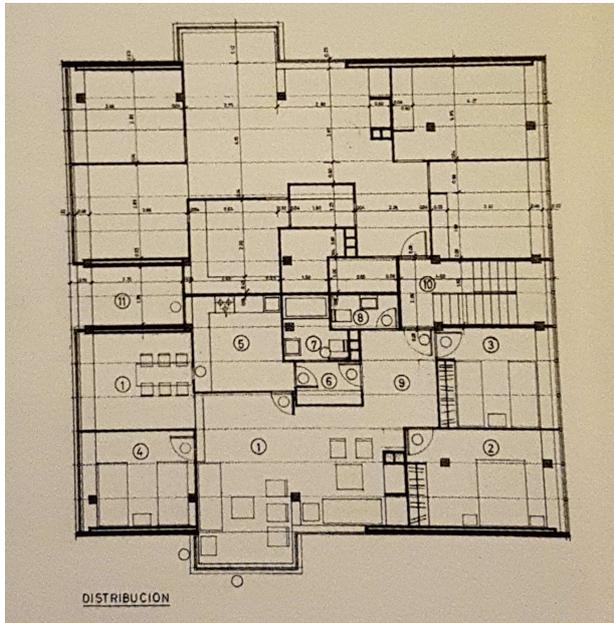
Planta Distribución T-2-3. 1964. Fuente: Archivo Municipal da Coruña
